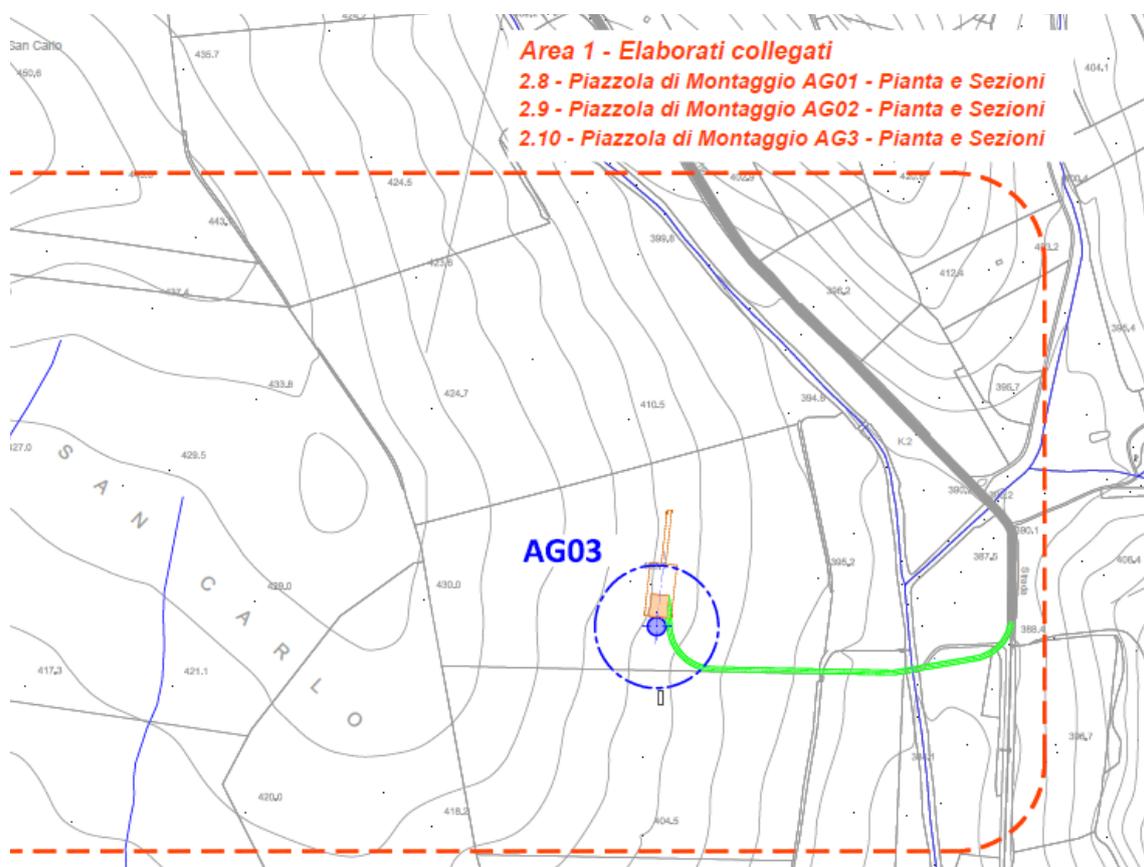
Estratto elaborato SPN_2.3B - Planimetria Area Impianto su CTR
